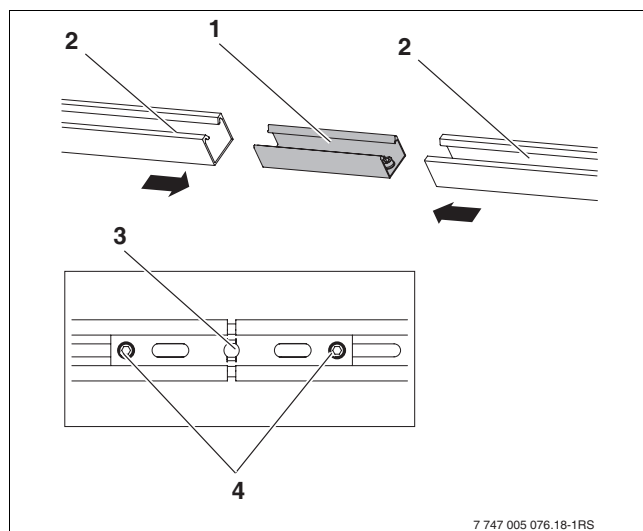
Unir los perfiles cubierta plana/tejado inclinado
